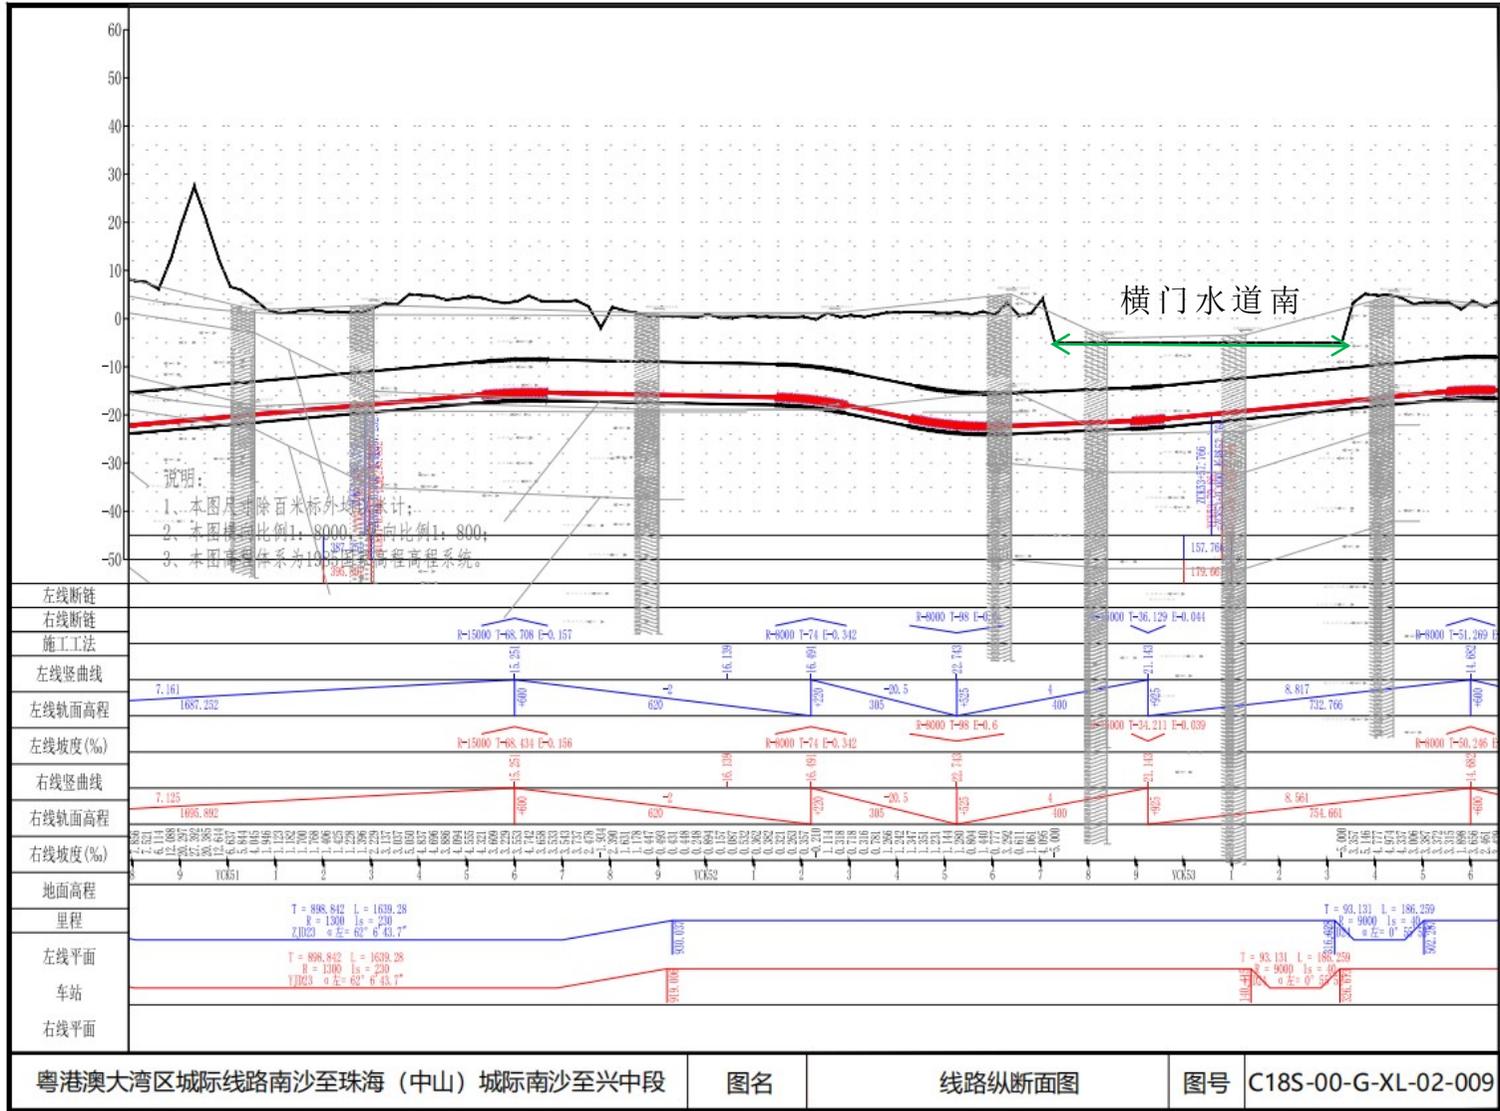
线路纵断面图（香山至火炬东站涉海工程段） 单位：m
